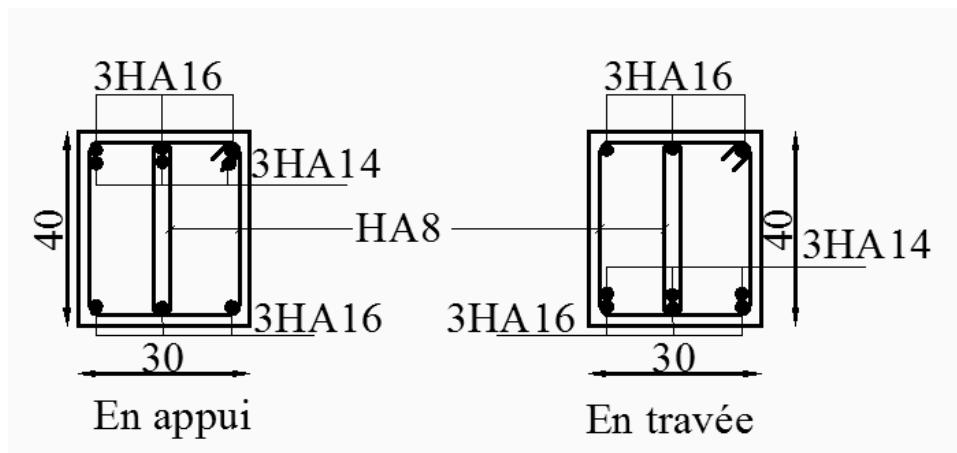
Schémas de ferrailage des poutres principales et secondaires
